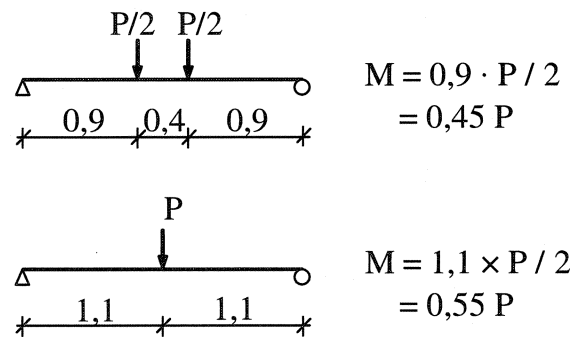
Cas de chargements de flexion sur dalle (dimensions en m)
